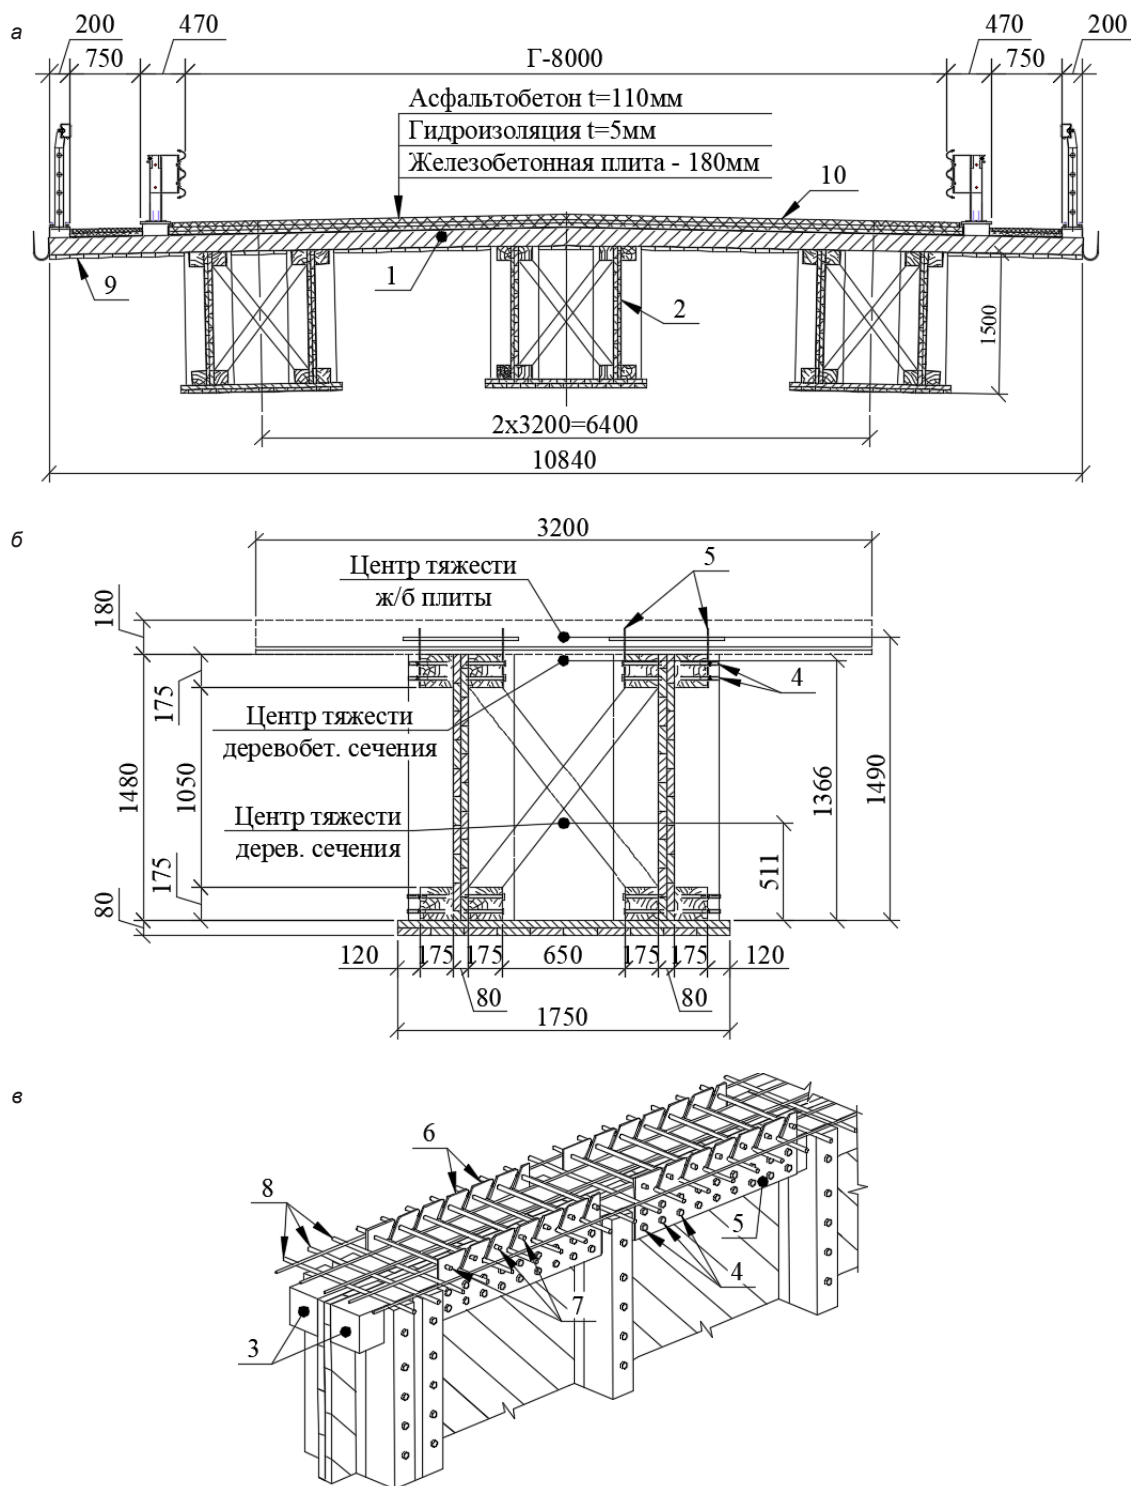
Поперечное сечение дощато-гвоздевого пролетного строения с монолитной железобетонной плитой проезжей части:
